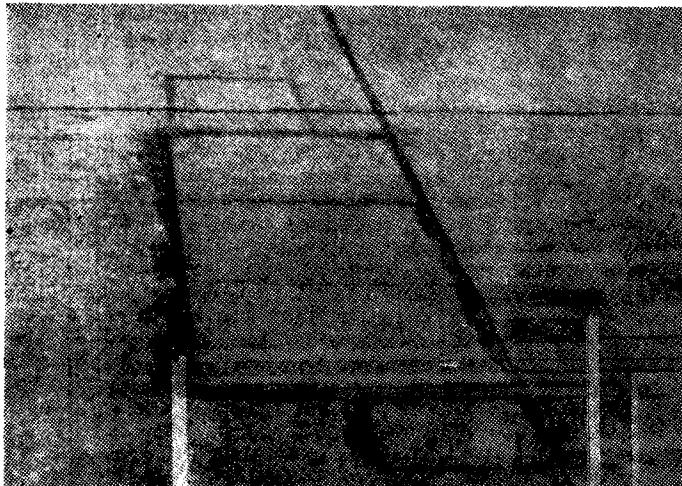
Вид покрытия после ремонта с использованием бетонных плит
